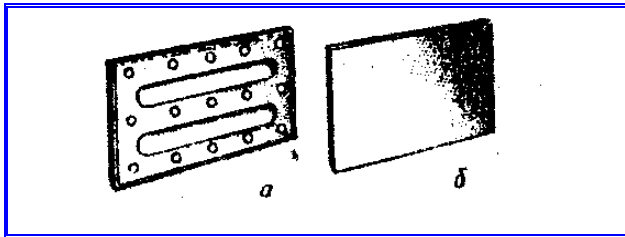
Малогабаритні фасадні плитки: а – тильна поверхня; б – лицьова поверхня
